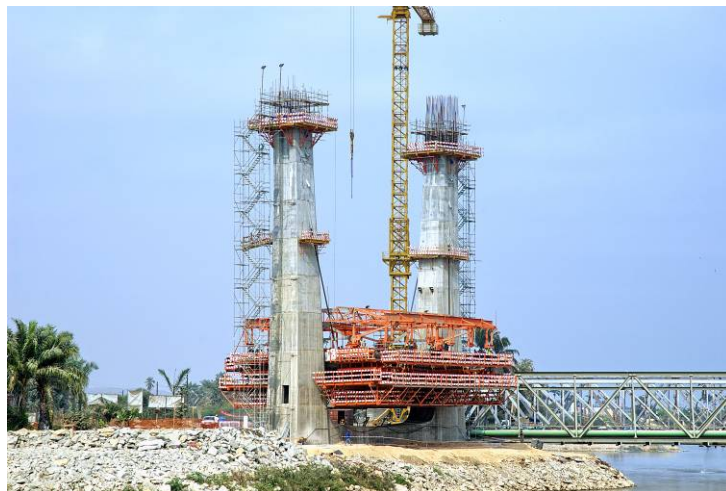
Cimbres de avanços - betonagem do 1º par de aduelas
